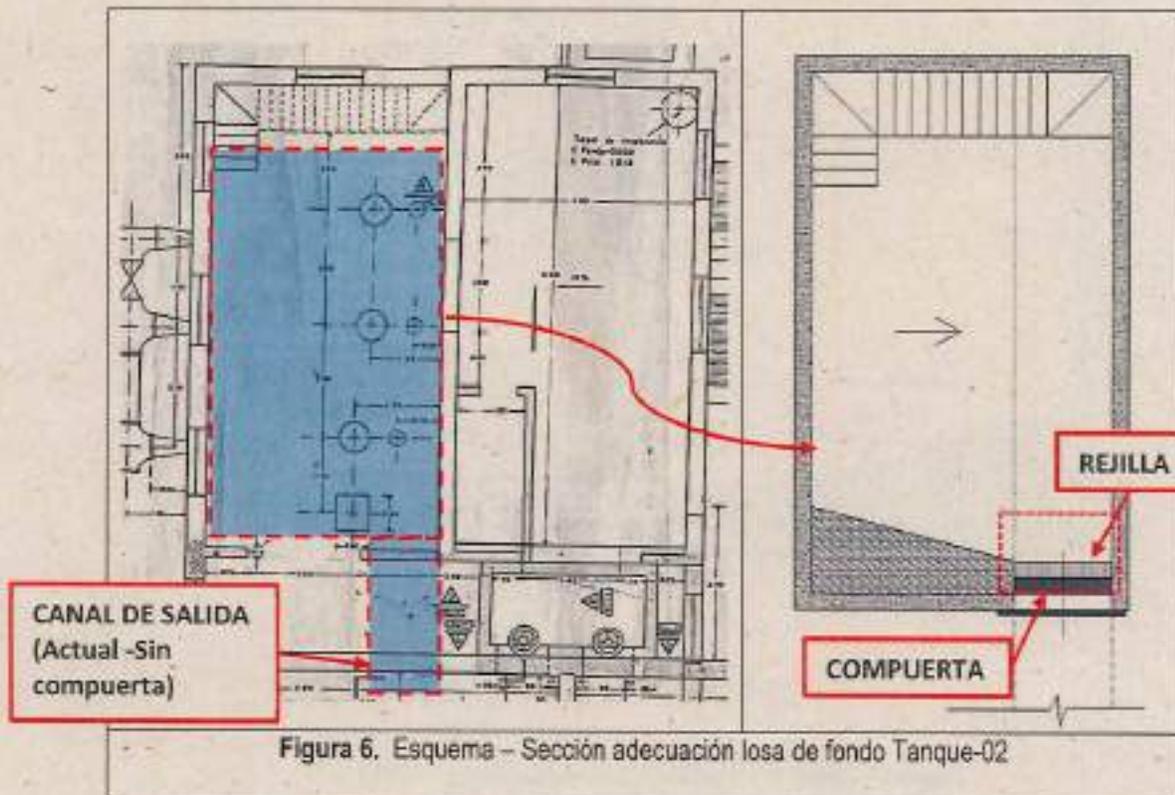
Esquema – Sección adecuación losa de fondo Tanque-02
